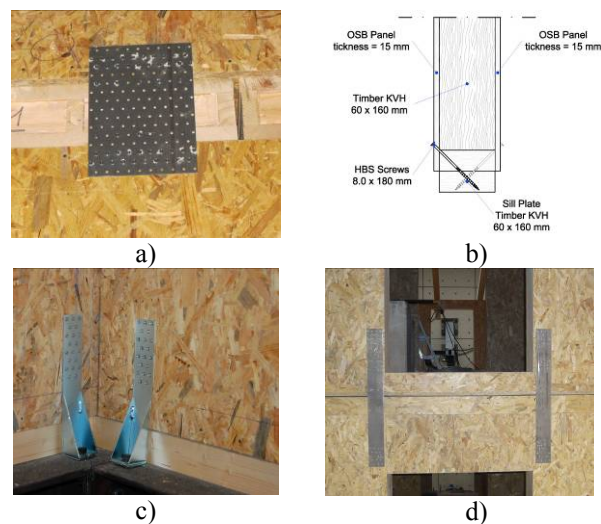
Dispositivi di collegamento . a: Piastre chiodate per la traslazione orizzontale delle pareti ai piani superiori - b: Viti a 45° per la traslazione orizzontale delle pareti al piano fondazione - c: Hold-down - d: Tie-down
